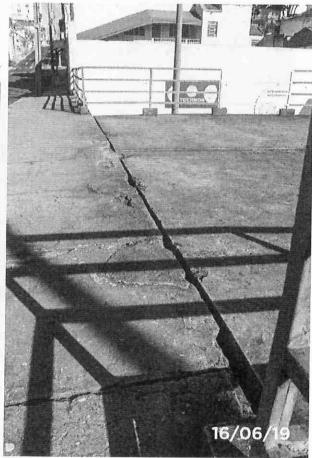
Detalhe da junta de dilatação entre Av. Brasil e a Passarela, apresentando segregação do concreto, trincas, desplacamento do concreto do Passeio.
